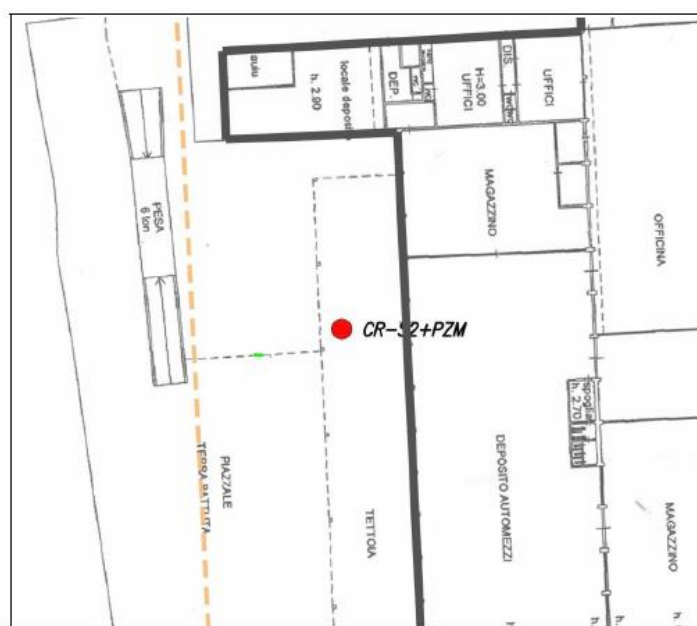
Planimetria ubicazione indagini e particolare della postazione 2/3
